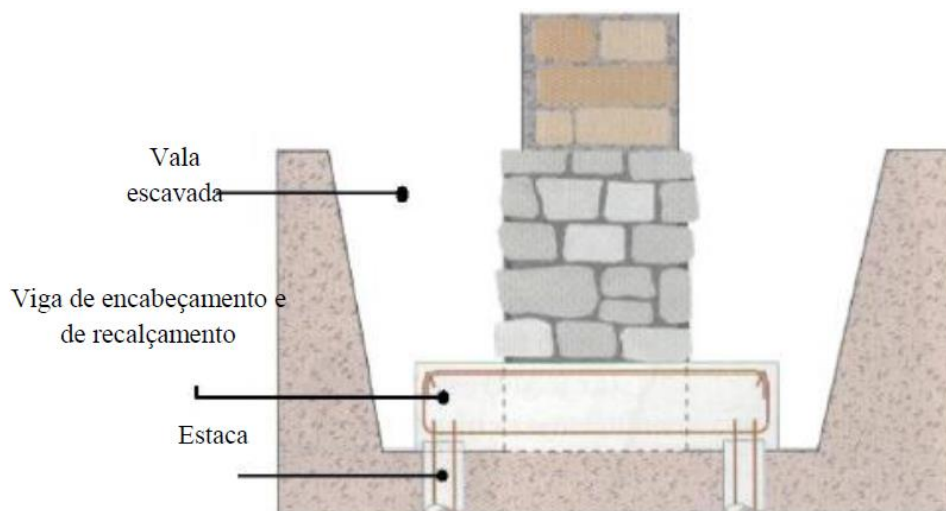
Representação esquemática do reforço da fundação por estacas em betão armado [24]
